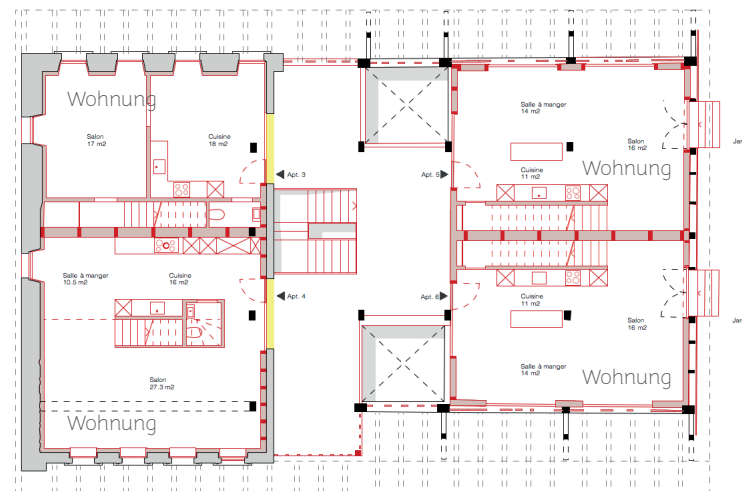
Grundriss Obergeschoss, Zeichnung: MHPM Architectes
